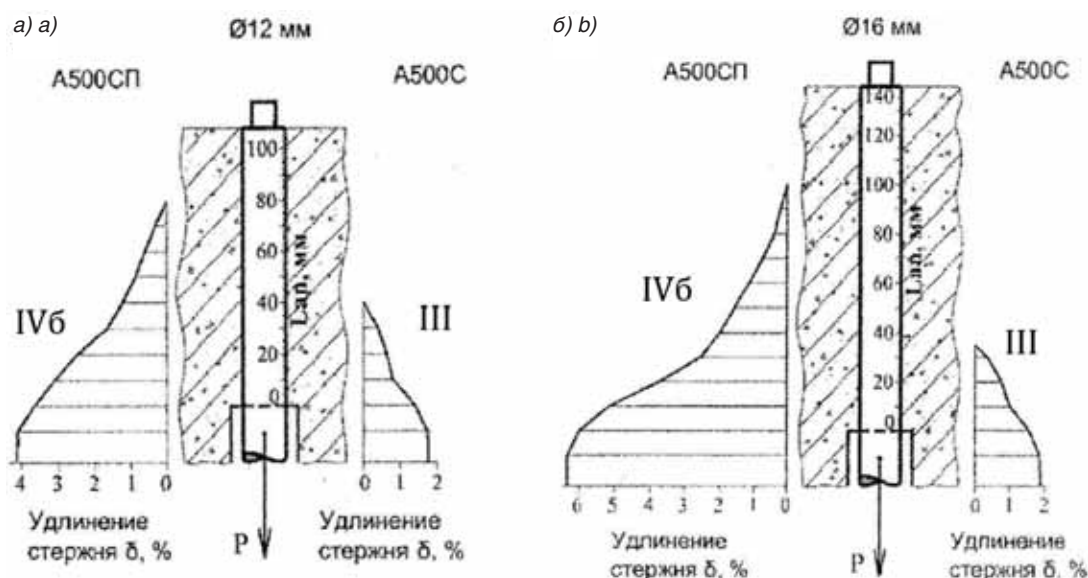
Распределение пластических удлинений арматурных стержней в пределах зоны заделки арматуры в бетон с $l_{an} = 9d$:
